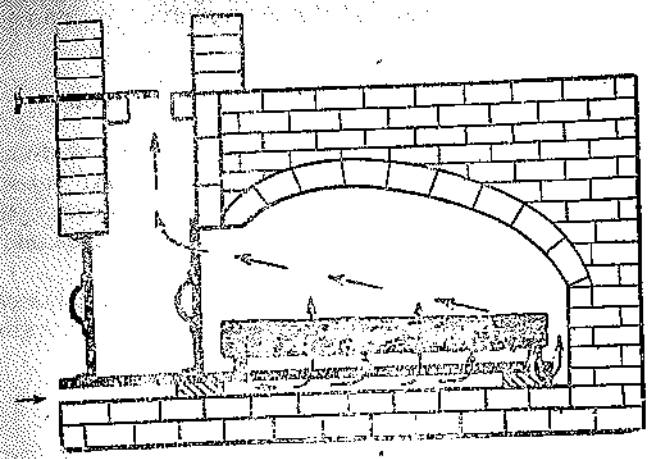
Приспособление русской печи для сушки по способу Маркова
